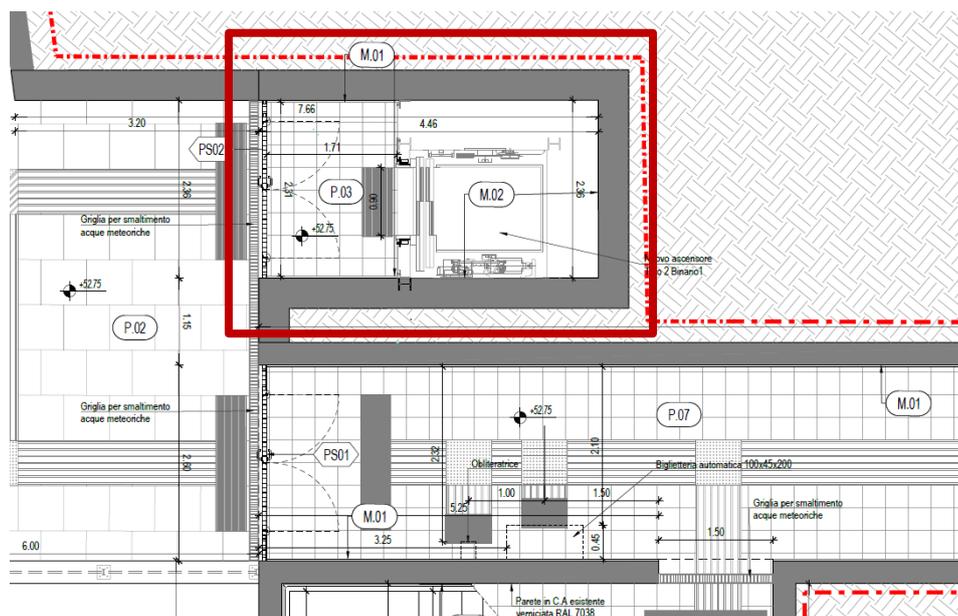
Blocco ascensore Nord - Pianta sottopasso
